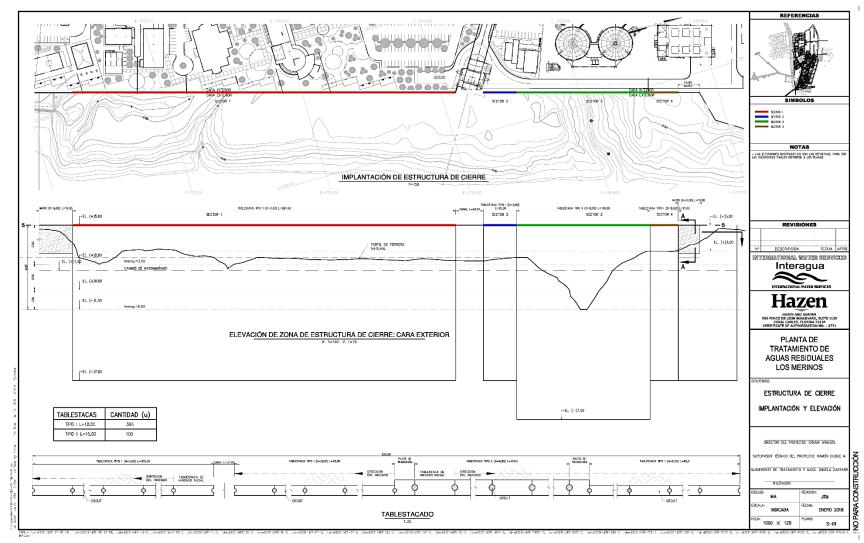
Estructura de Cierre – Implantación y Elevación.
